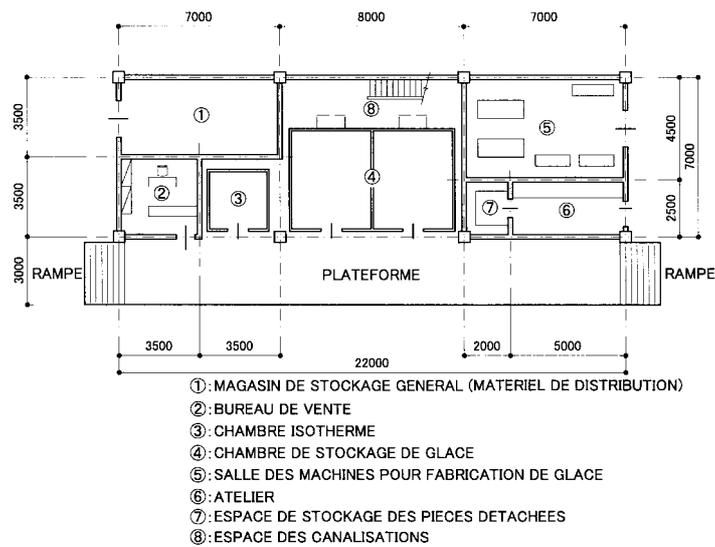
Plan planimétrique des installations de fabrication de glace
